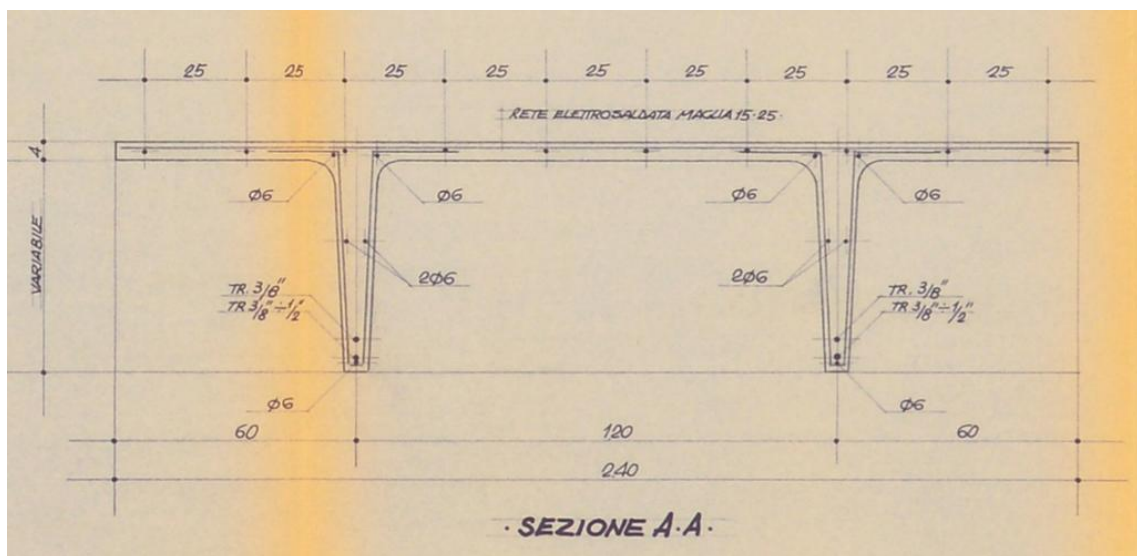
Particolare di A.1980.cap.us.T06 - Dettagli armature tegoli di copertura - Sezione trasversale in mezzeria
